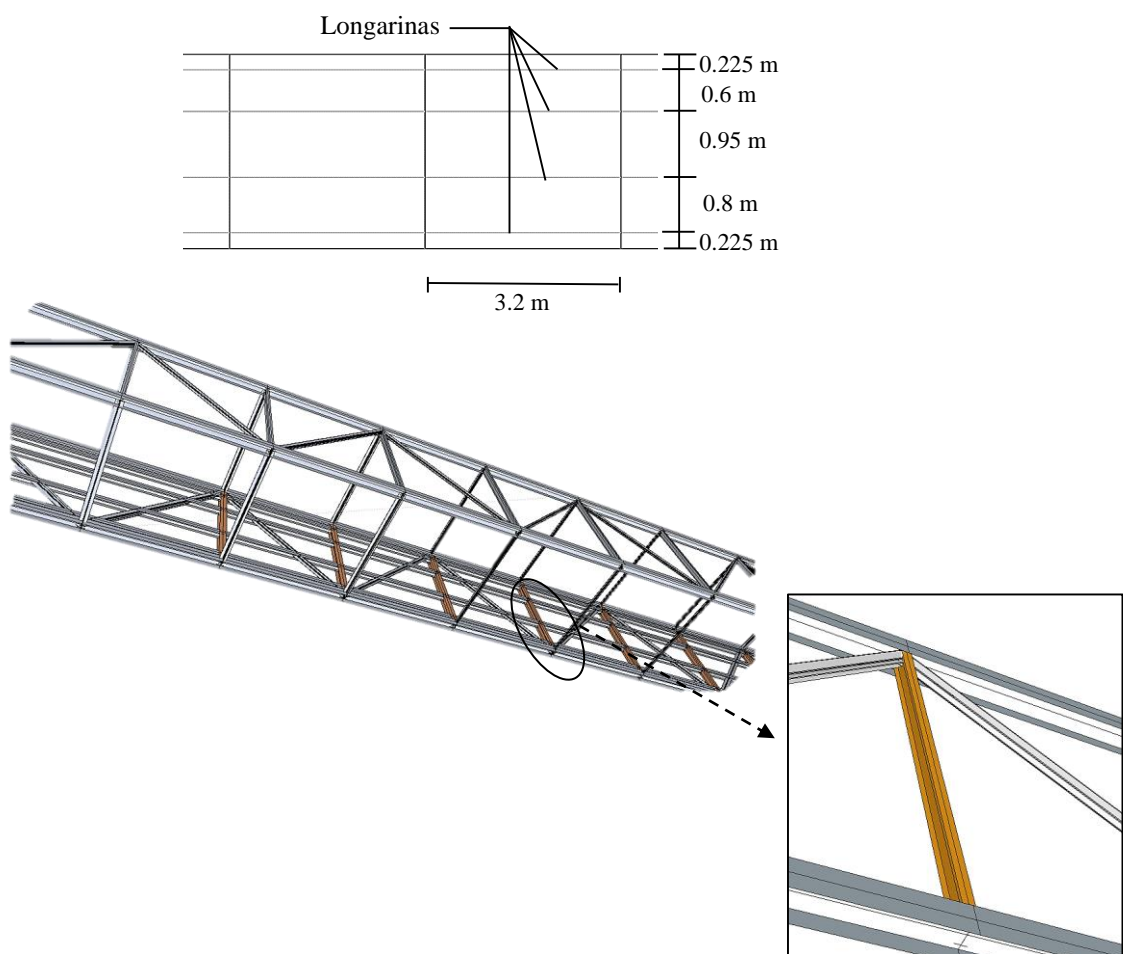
Planta e Pormenores de um troço da Ponte com a posição das Carlingas e das Longarinas
